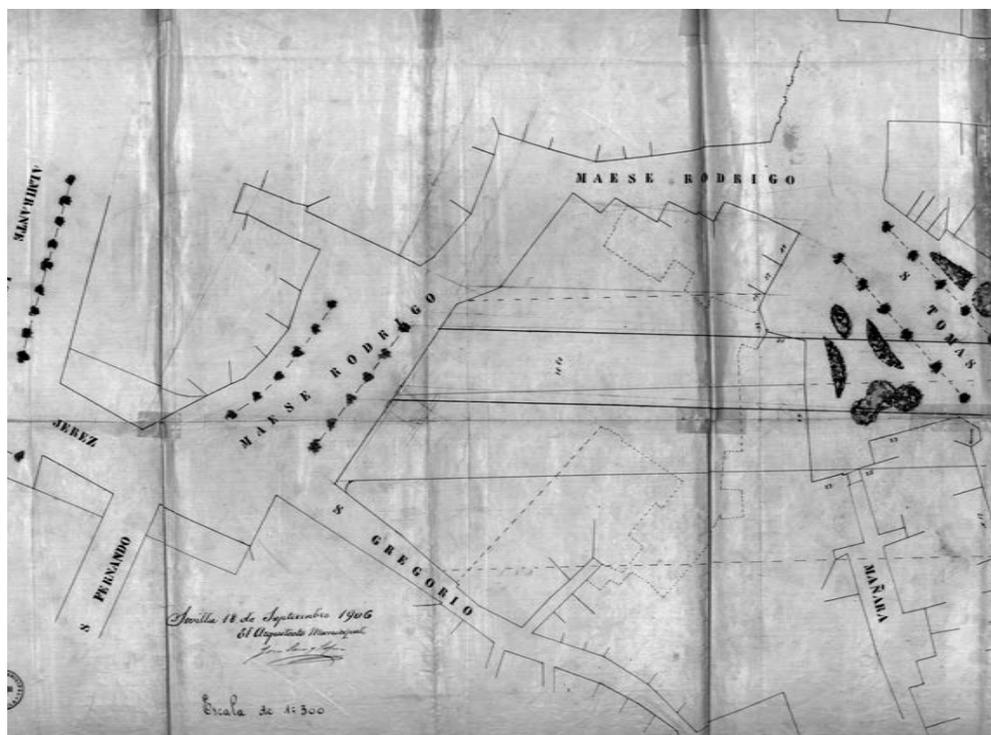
Detalle del plano de apertura de la Avenida de José Sáez López, 1906. El primer trazado intenta conectar directamente la puerta de Jerez, atravesando Santa María de Jesús a través de su capilla.
